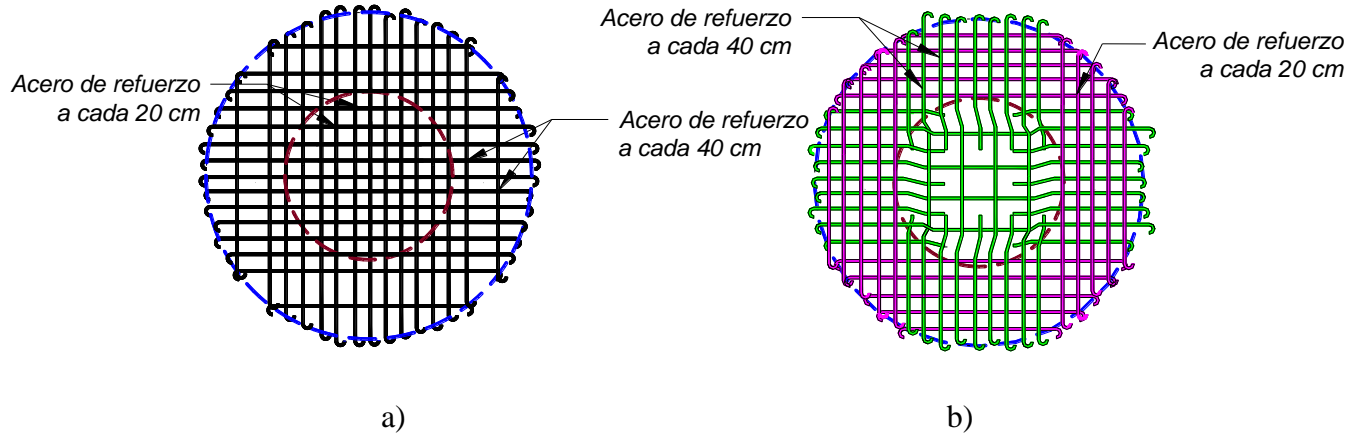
Propuesta del acero de refuerzo en placas circulares donde: a) refuerzo positivo y b) refuerzo negativo
